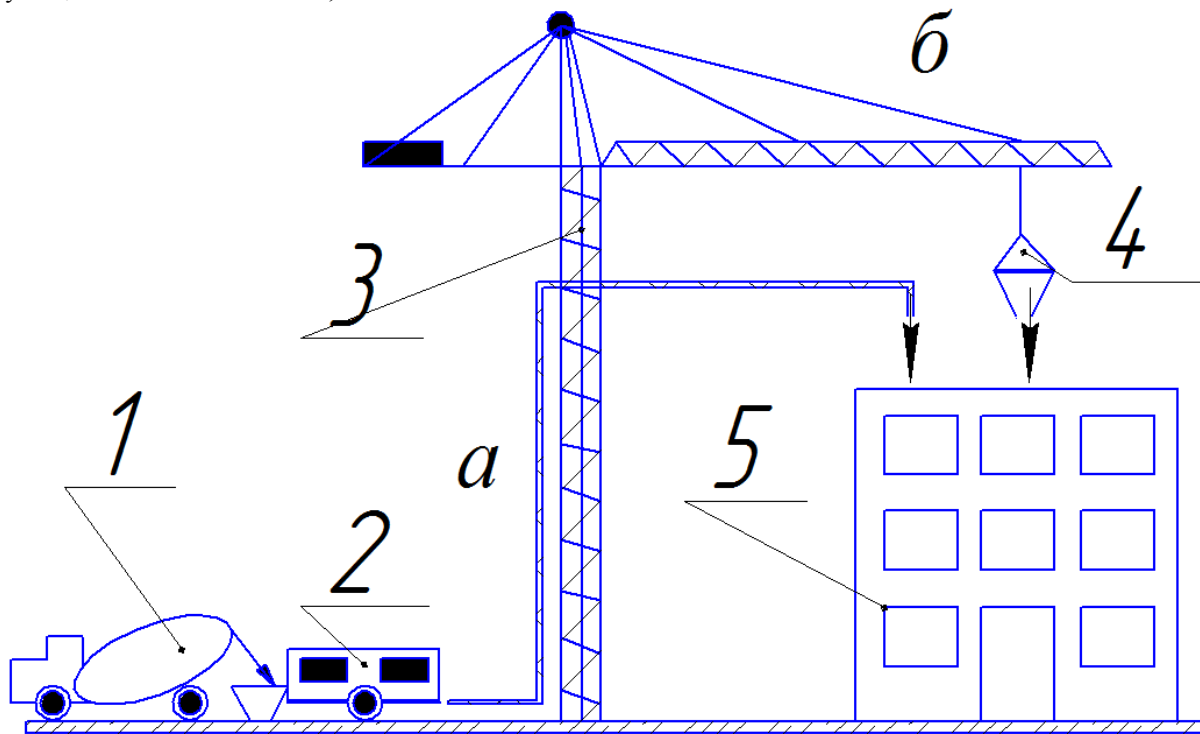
Існуючі технології укладання бетонної суміші при будівництві будівель і споруд: а – бетононасосом; б – краном
